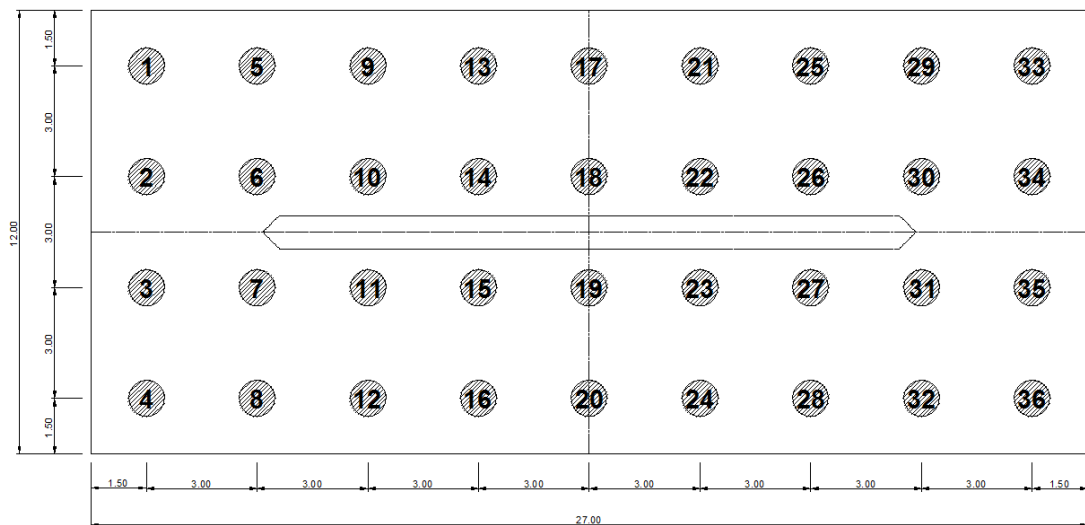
Distribución en planta de los pilotes para la pila P3.
